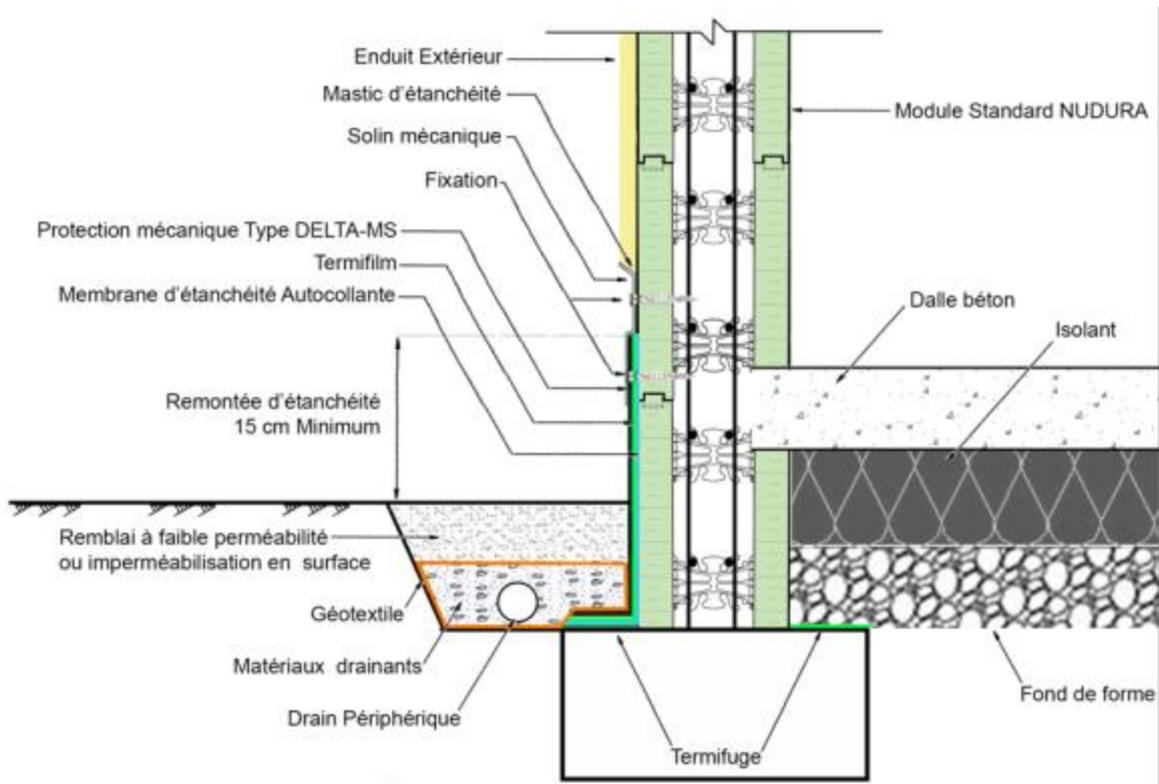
Traitement termite – Périphérie dallage sur terre-plein isolé et porté
